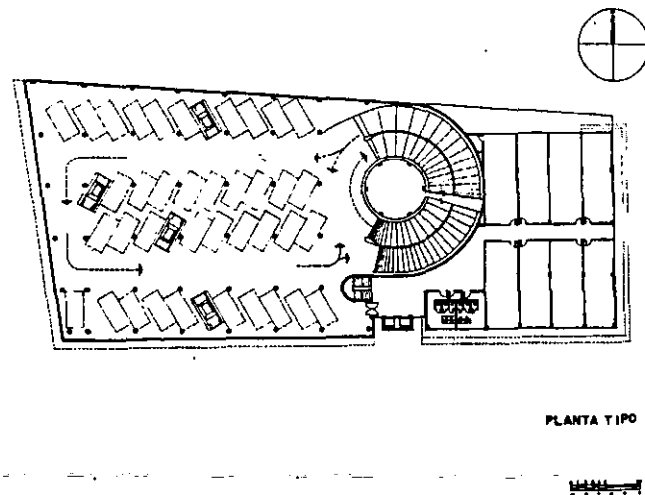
Edificio El Dorado, planta tipo (AOV).
